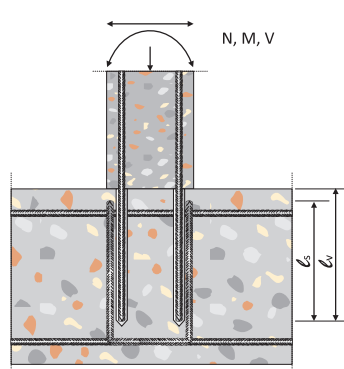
Giunto di sovrapposizione alla base di un pilastro o di un muro in fondazione, dove gli elementi sono sollecitati in trazione.
